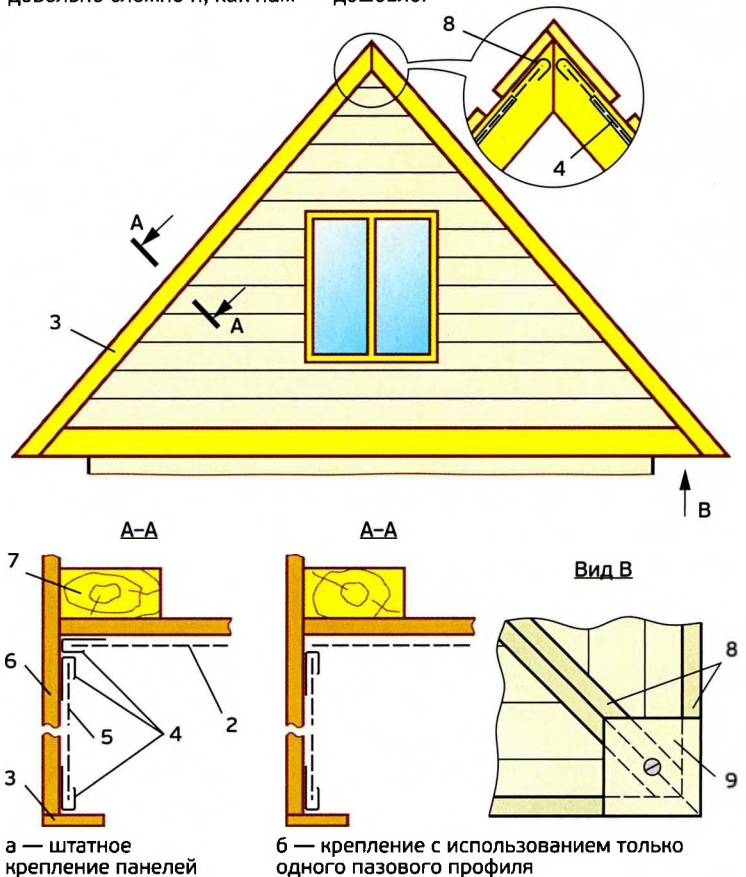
Облицовка фронтонов: 1 — дощатая обшивка фронтона; 2 — виниловая облицовка фронтона; 3 — лобовая доска; 4 — пазовые (тип J) элементы; 5 — облицовка свесов обрешётки (фронтонных свесов); 6 — обрешётка; 7 — стропило; 8 — финишные профили; 9 — декоративная пластина.
